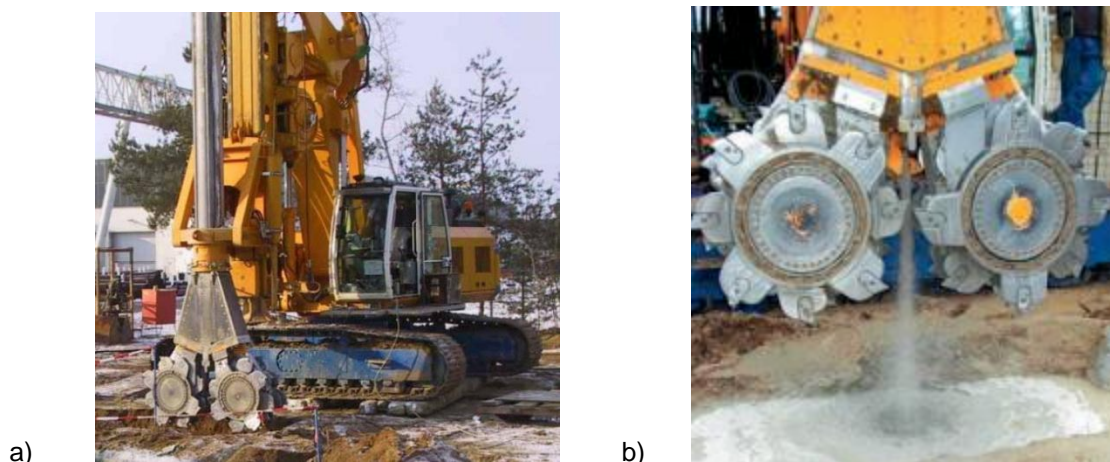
Equipamento CSM: a) vista geral (Wilson, 2007) b) pormenor da saída do ligante (BAUER Group)
